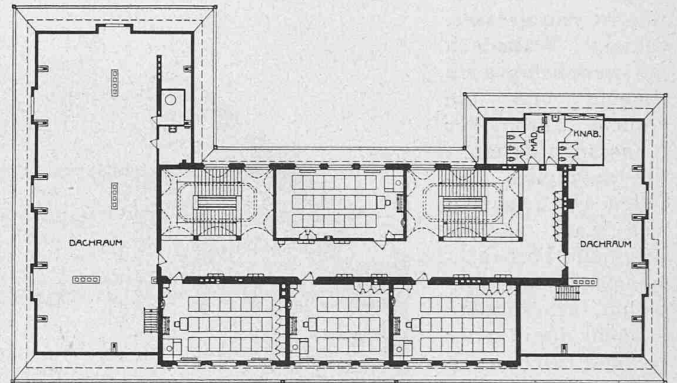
Grundriss vom Dachstock. — 1:600.
